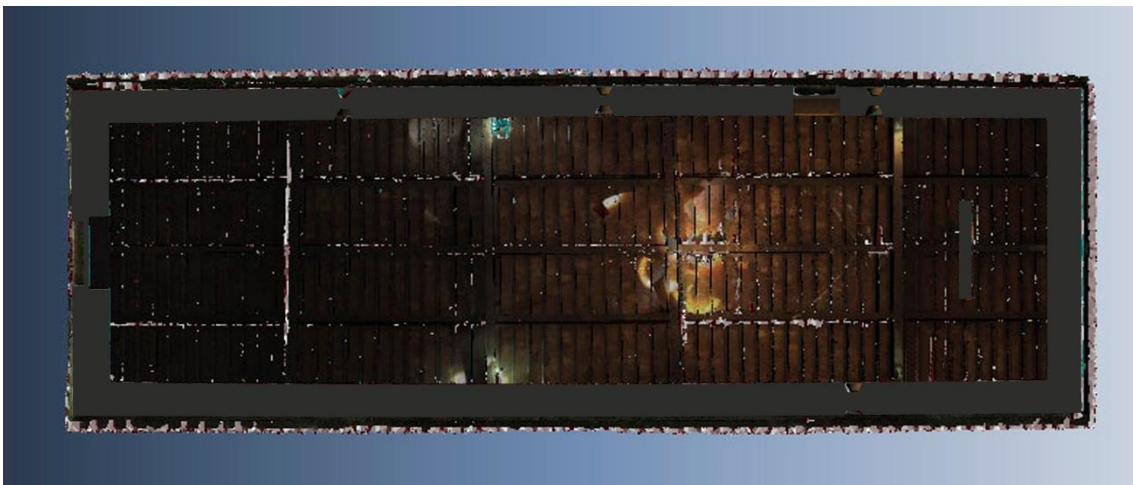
Sección horizontal visualizando la cubierta desde el interior.
